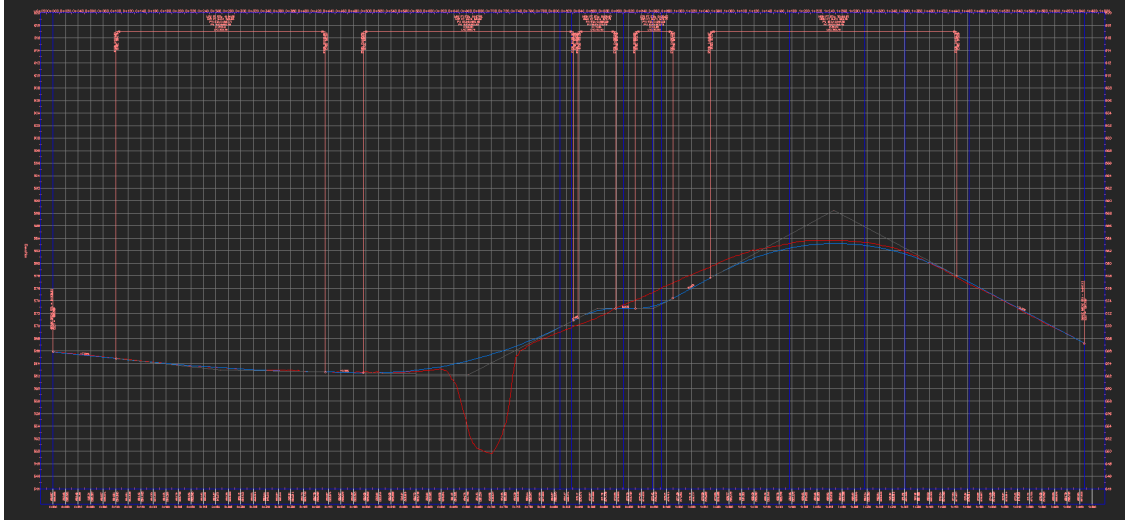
Alzado N-344. Fuente: Elaboración propia.
